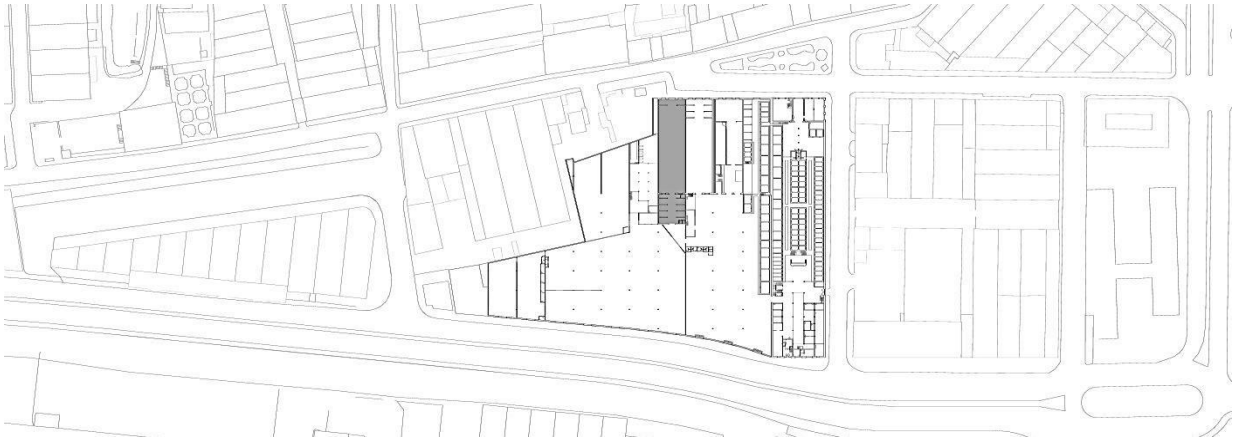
Planta de levantamento fotográfico piso térreo – Armazém 10.
